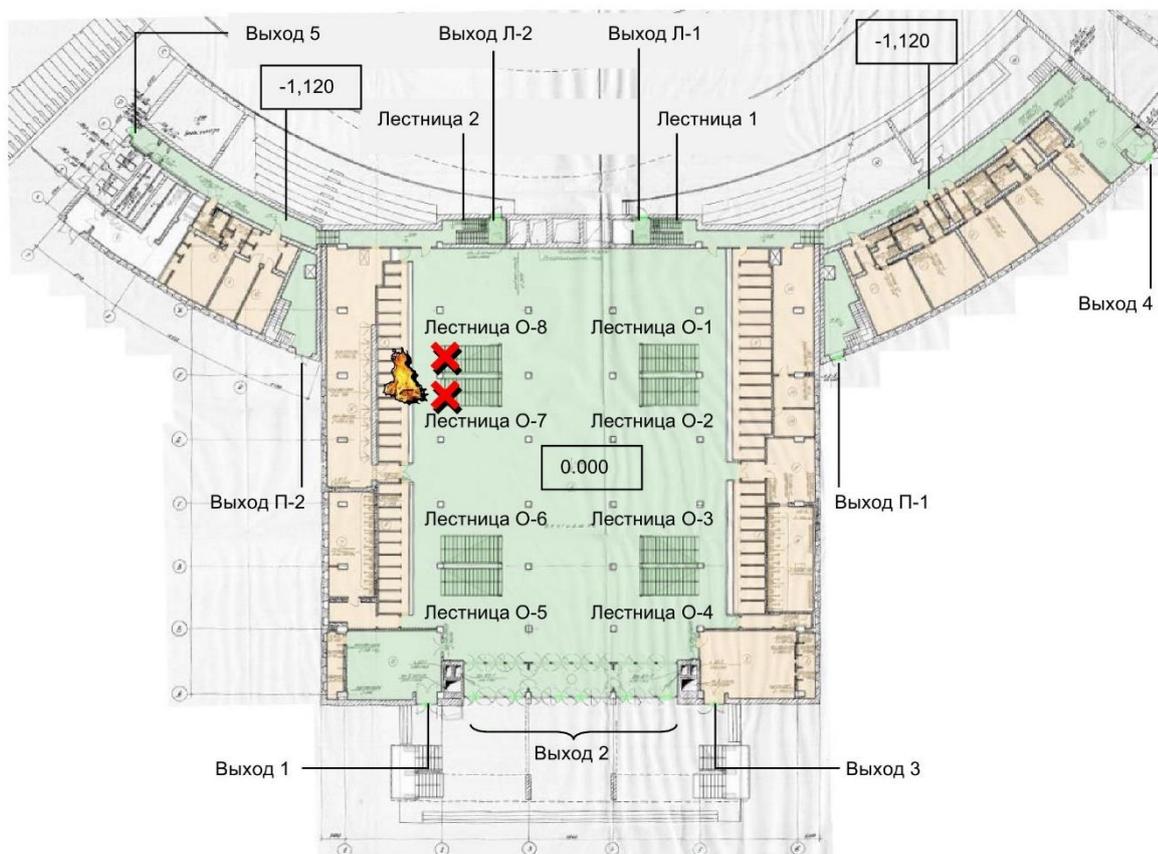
Наиболее опасный сценарий пожара на 1-м этаже
